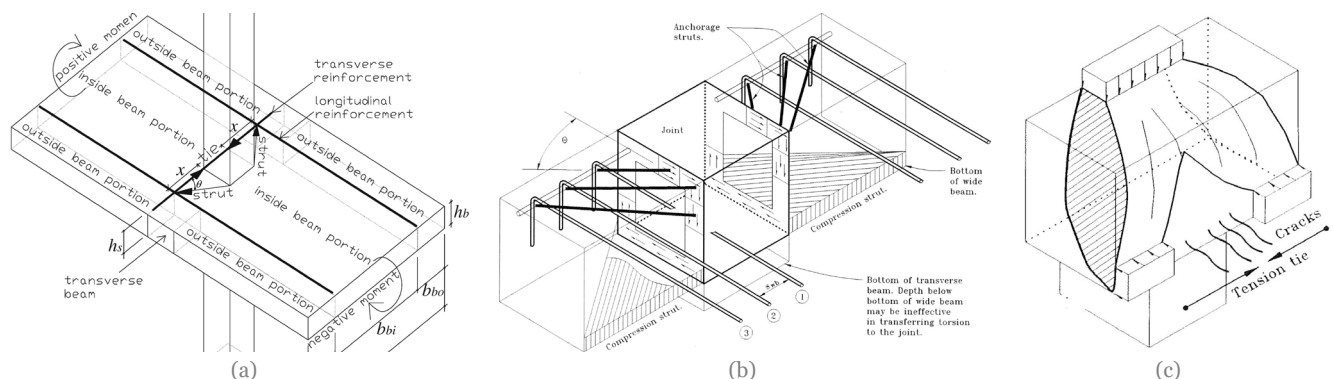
Diversos modelos de conexión viga plana-pilar: franja central de bielas-tirantes y externas de torsión (a (28)), bielas exteriores a nudo en ancho efectivo (b (12)) y biela combinada con nudo (c (12)).
